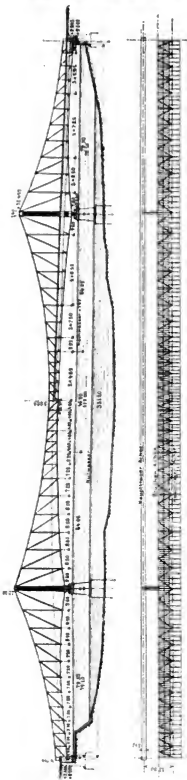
Längsansicht, — Schnitt und Grundriss. 1:1500.
